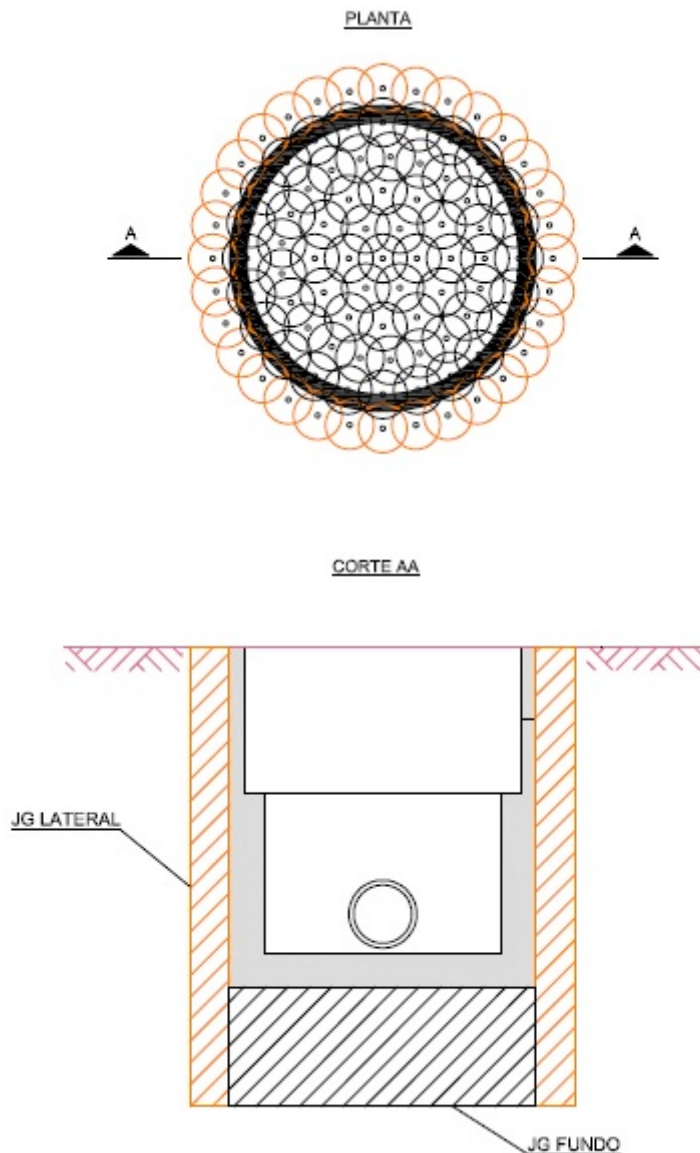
Consolidação de Poço com colunas de Jet-Grouting
